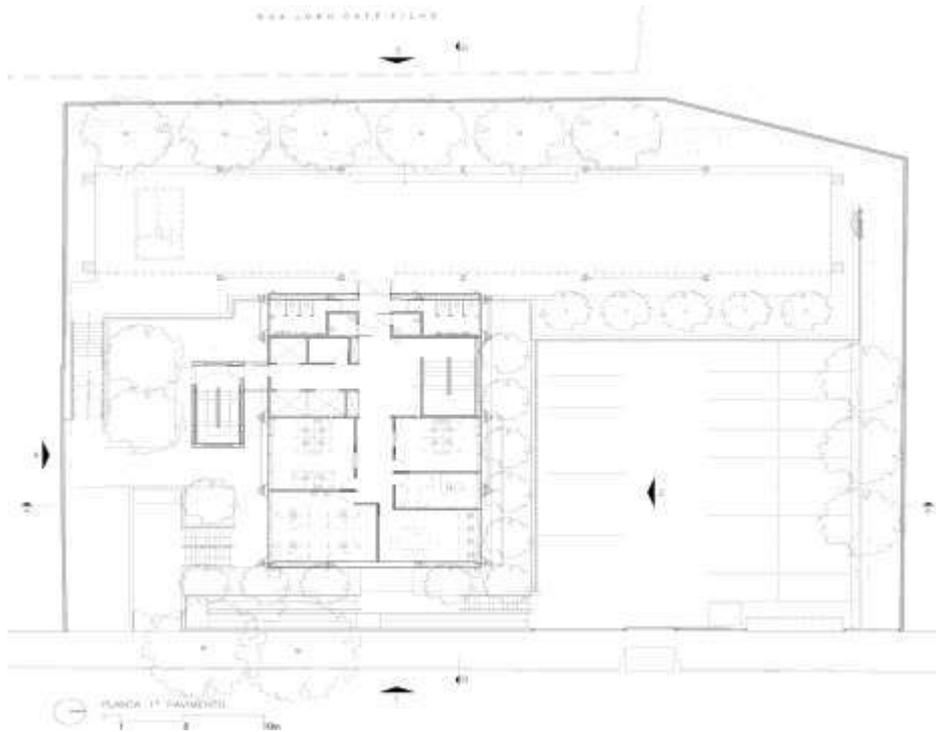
SENAC - Taboão da Serra - Planta Baixa pv. Térreo.
